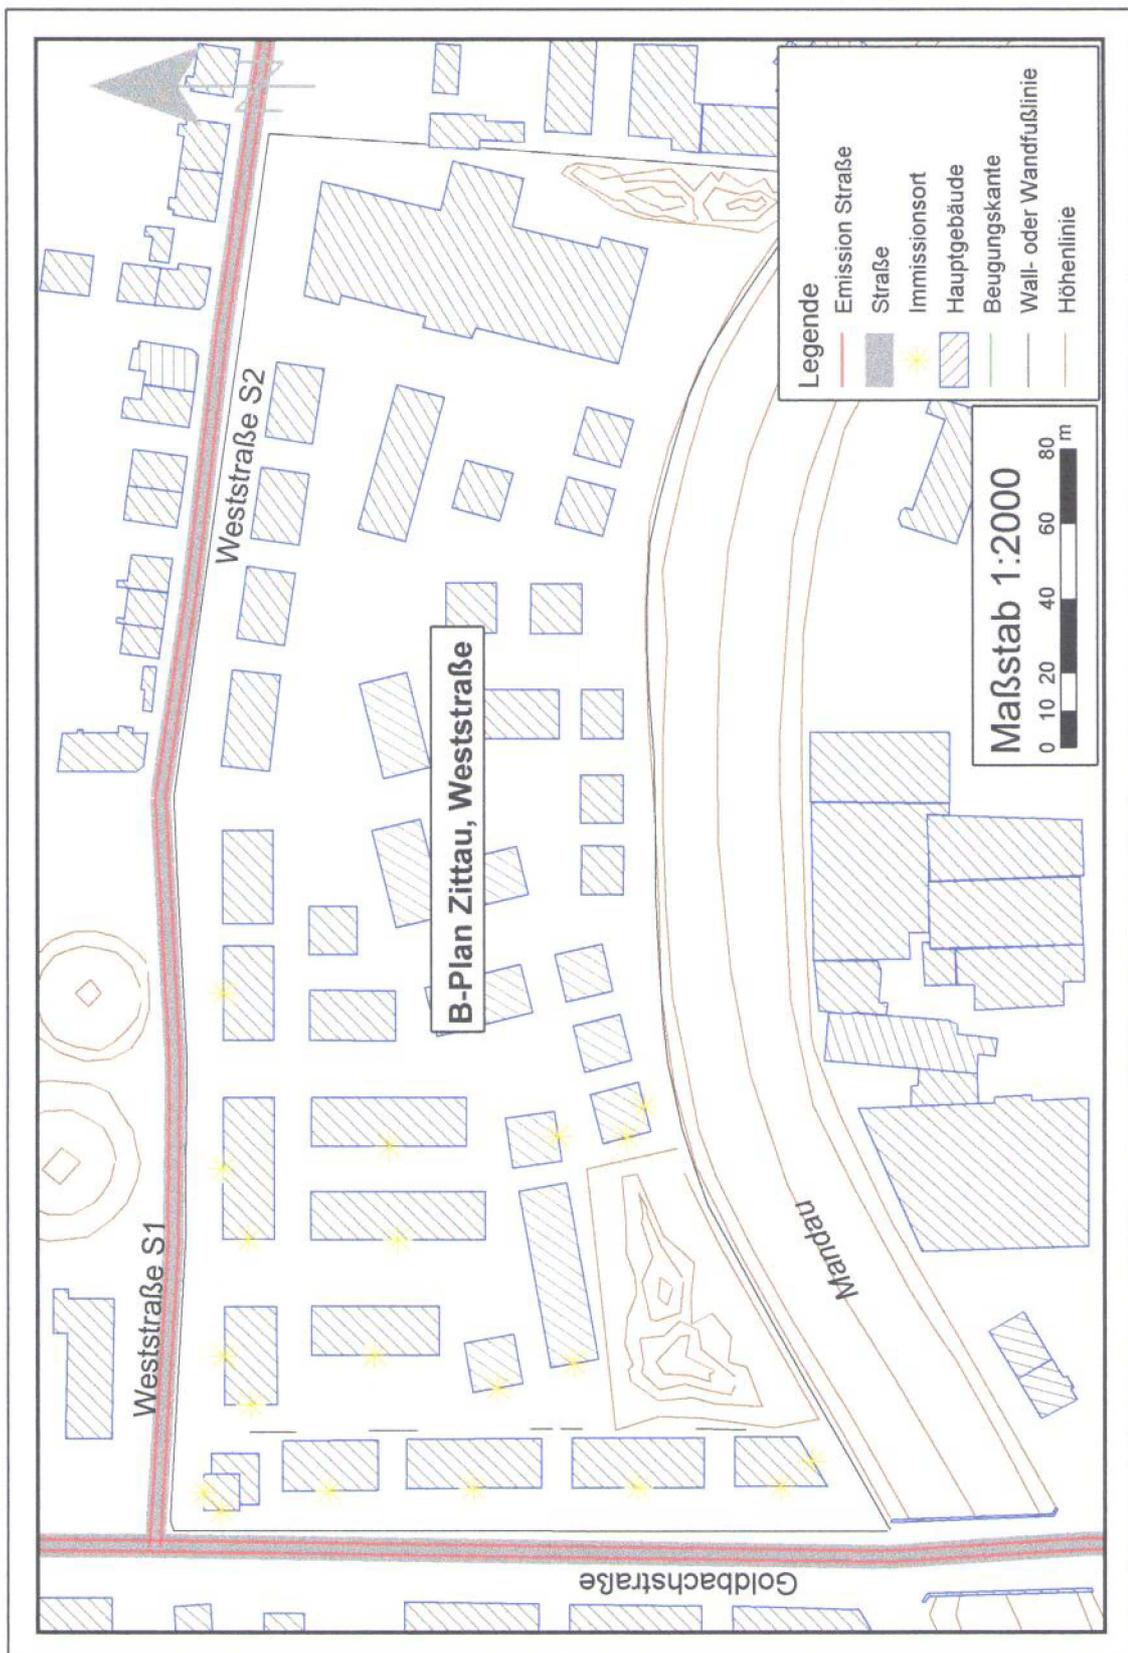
Lage der geplanten Bebauung Zittau, Weststraße
